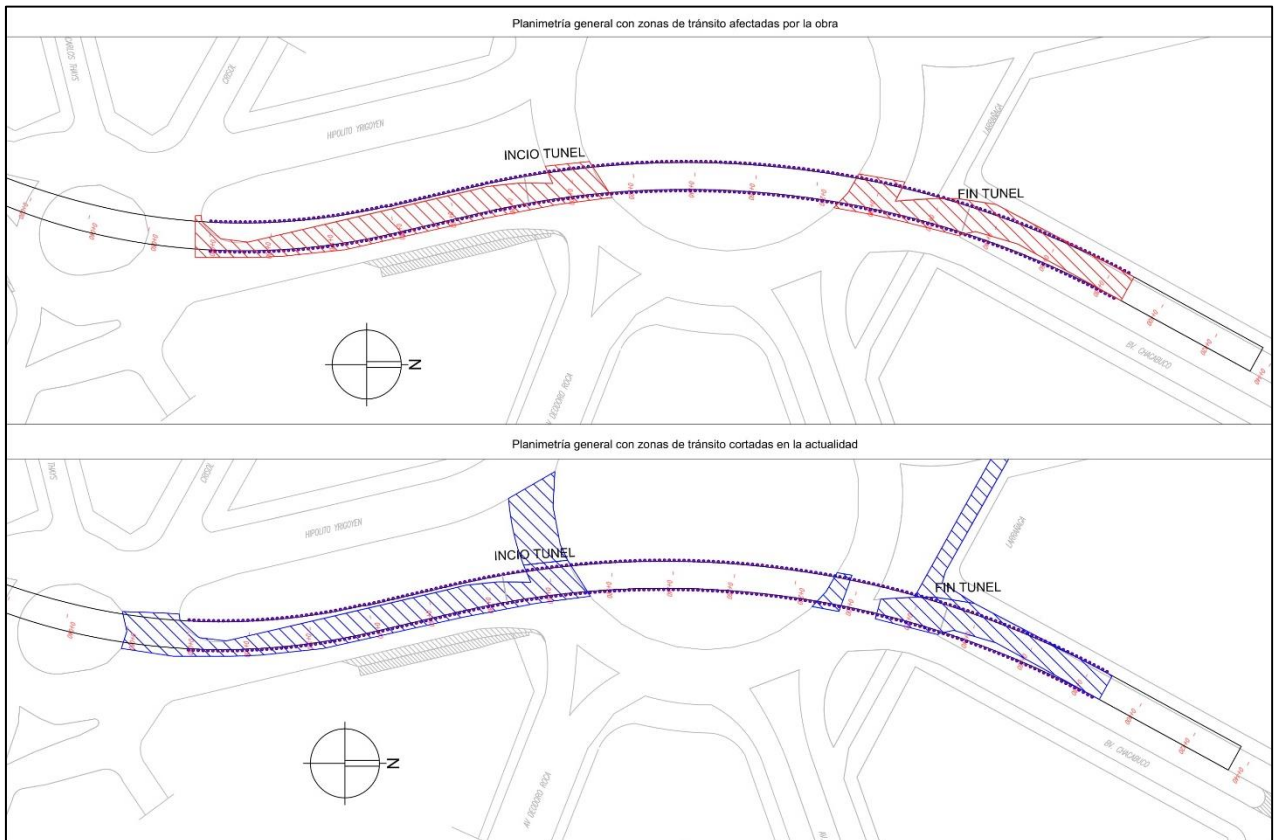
Zonas de tránsito afectadas por la obra y zonas de tránsito cortadas en la actualidad. (PLANO N° 8)
